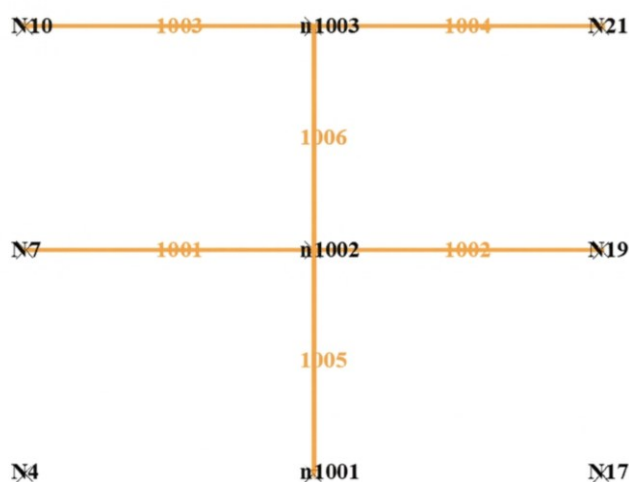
Prospetto Parete XLAM 4 - Modello Scollegato
